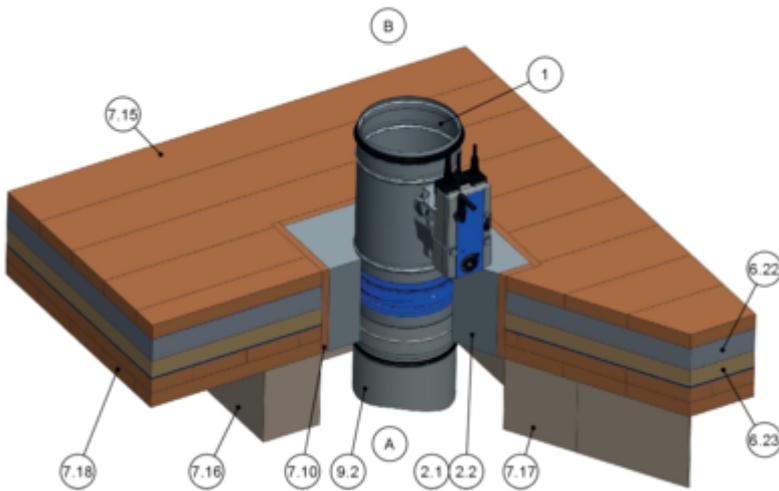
Trockeneinbau in Holzbalken-/Leimbinderdecke mit Einbausatz TQ2, hängend (Abbildung stellvertretend, alternativer Deckenaufbau auf Anfrage möglich)
